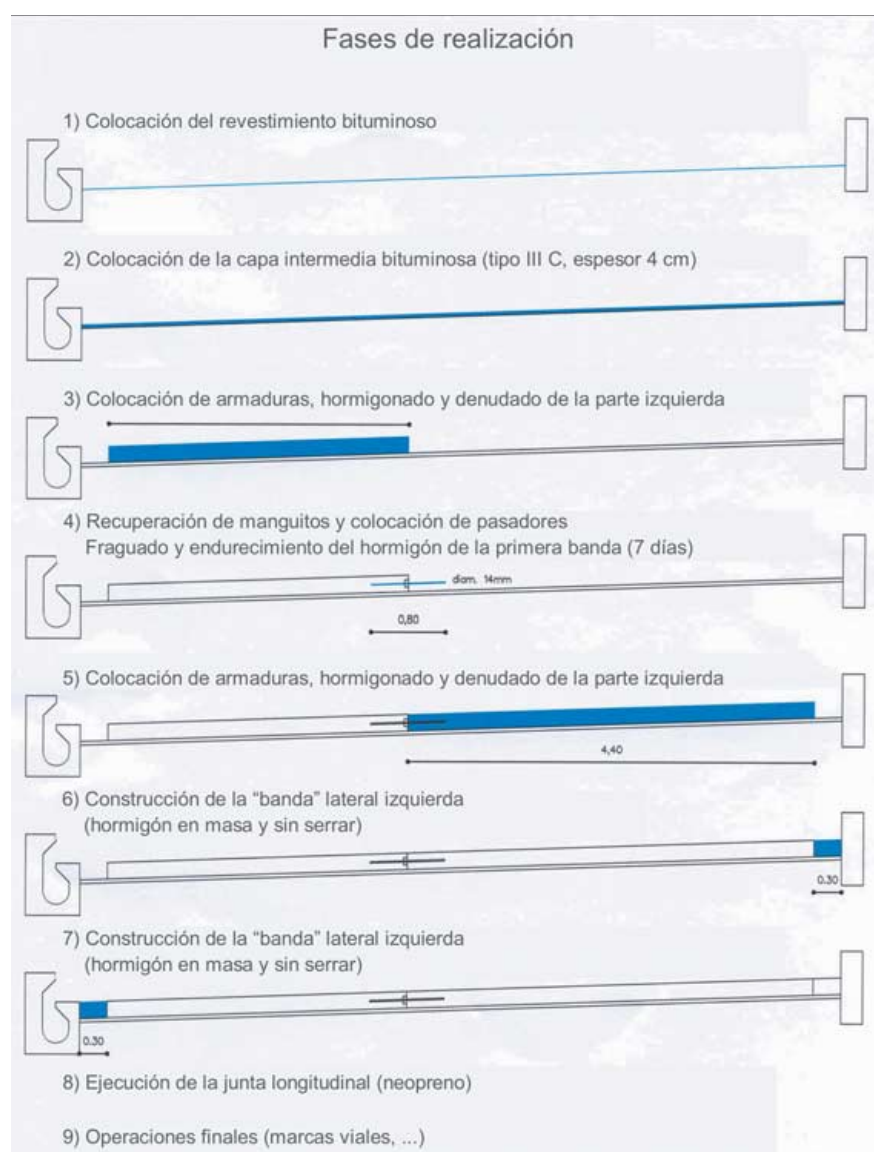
Túnel de Cointe (Lieja): fases de construcción del firme.
